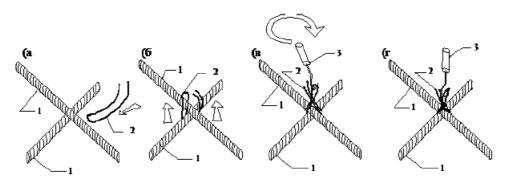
Схема фиксации арматурных стержней вязальной проволокой:
